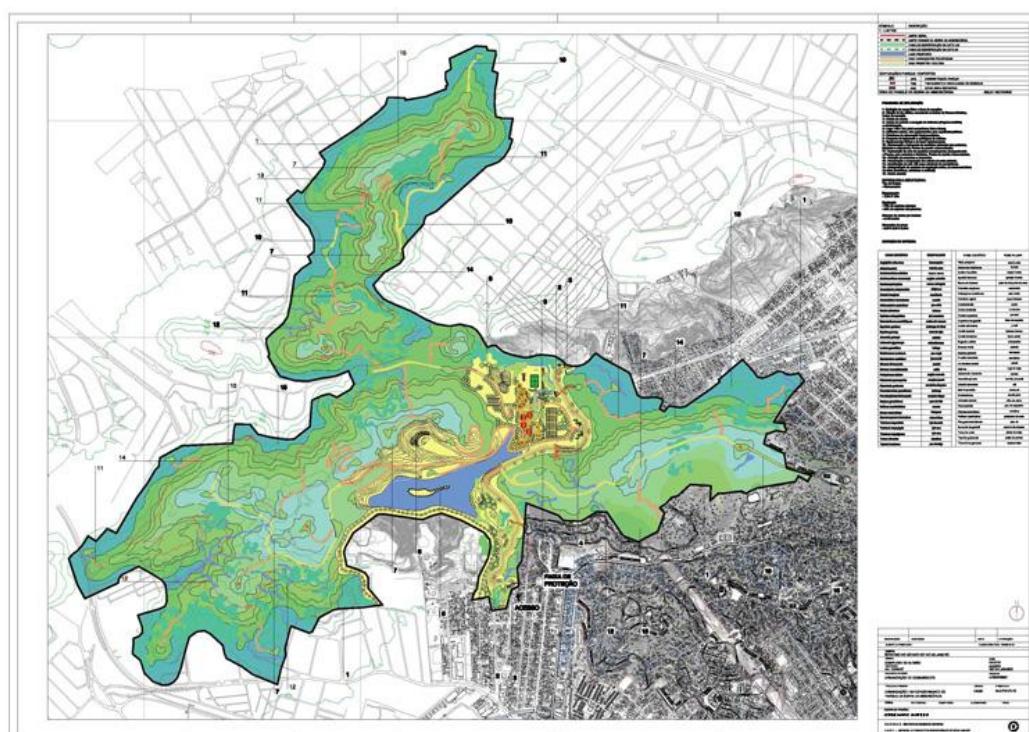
Projeto arquitetônico do Parque da Serra da Misericórdia previsto no Plano de Desenvolvimento Urbanístico do Complexo do Morro do Alemão. Fonte: http://www.jauregui.arq.br/favelas_alemao.html
